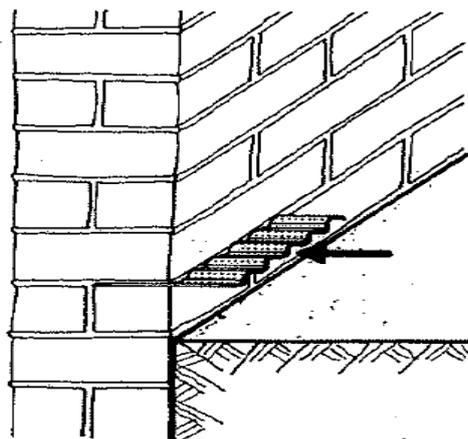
Exemplo de inserção de um perfil metálico na junta horizontal de uma parede⁷
